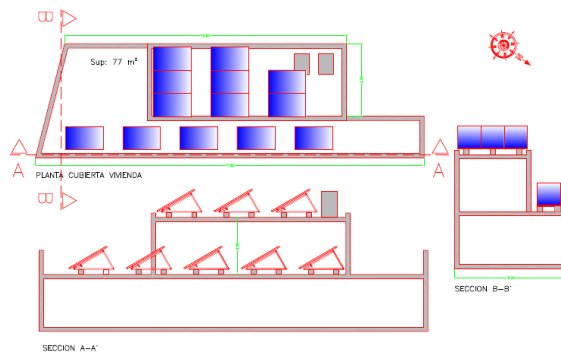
Distribución en Planta y Sección Instalación. Edificio 1
